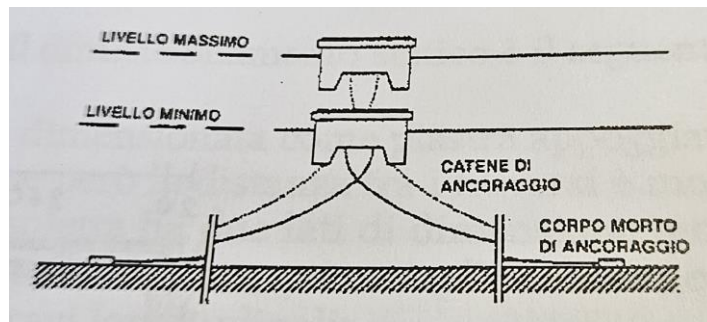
Sistema di ancoraggio e sezione trasversale di un pontile galleggiante ancorato al fondo con catene
